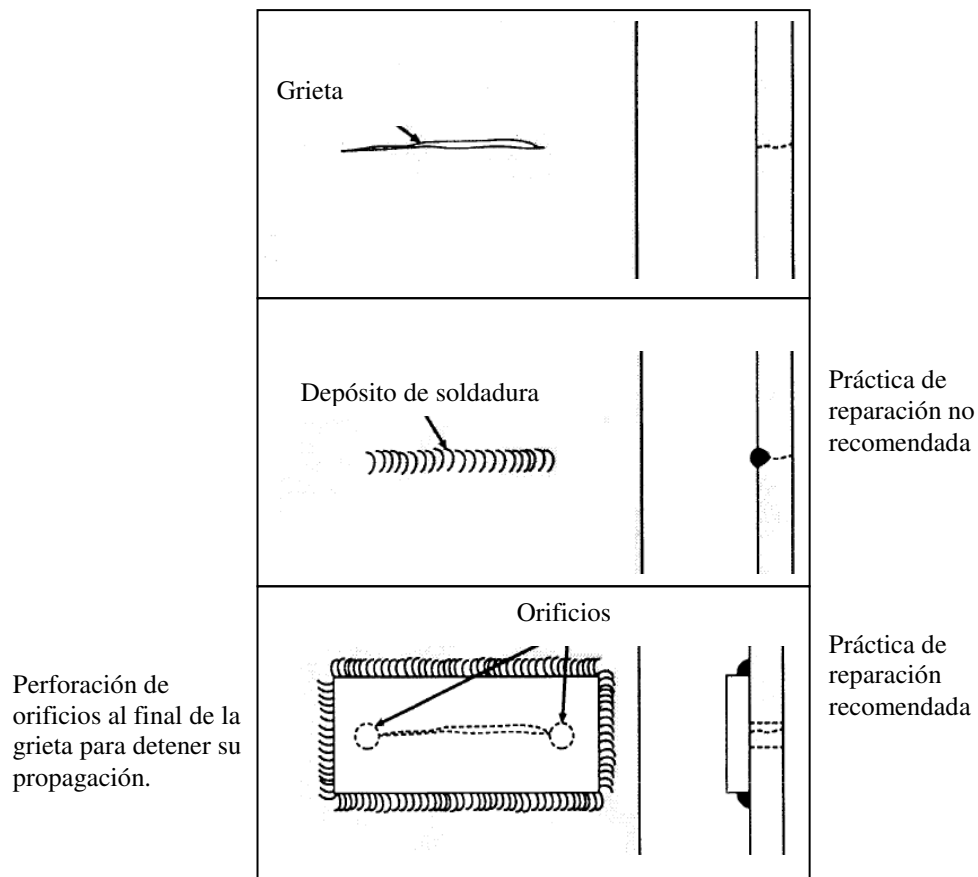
Método para reparación de grietas en estructuras submarinas utilizando parches rectangulares [7].
